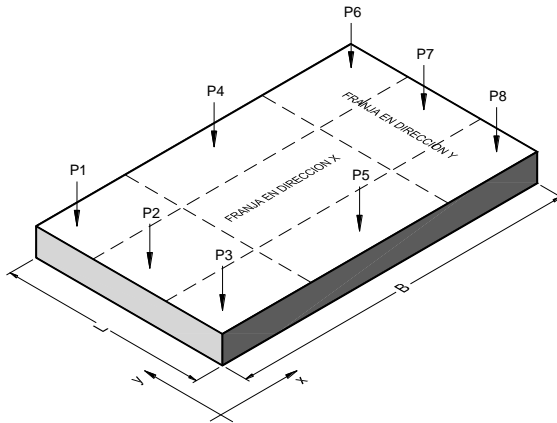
División en franjas de la losa de cimentación para comprobación de rigidez
